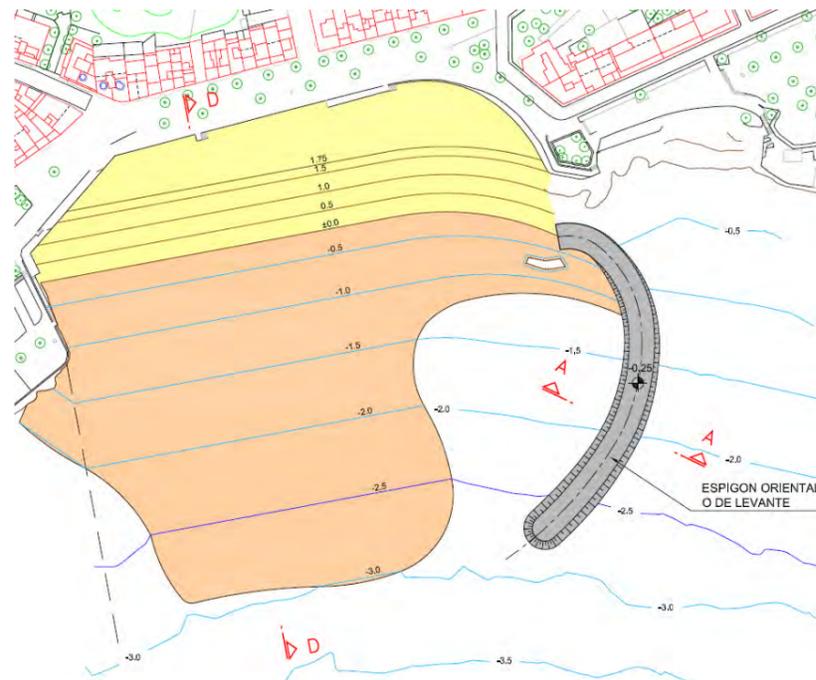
Planta de la Variante 1 de la Alternativa 5. (Fuente: Elaboración propia)
